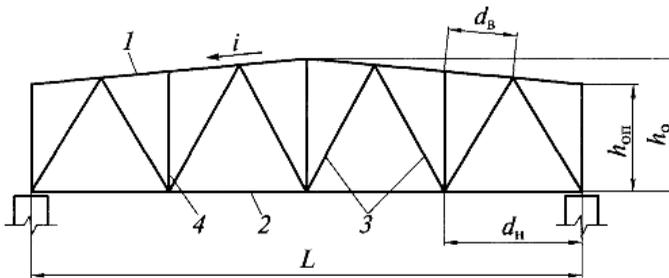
Елементи ферм: 1 - верхній пояс; 2 - нижній пояс; 3 - розкоси; 4 - стійка
